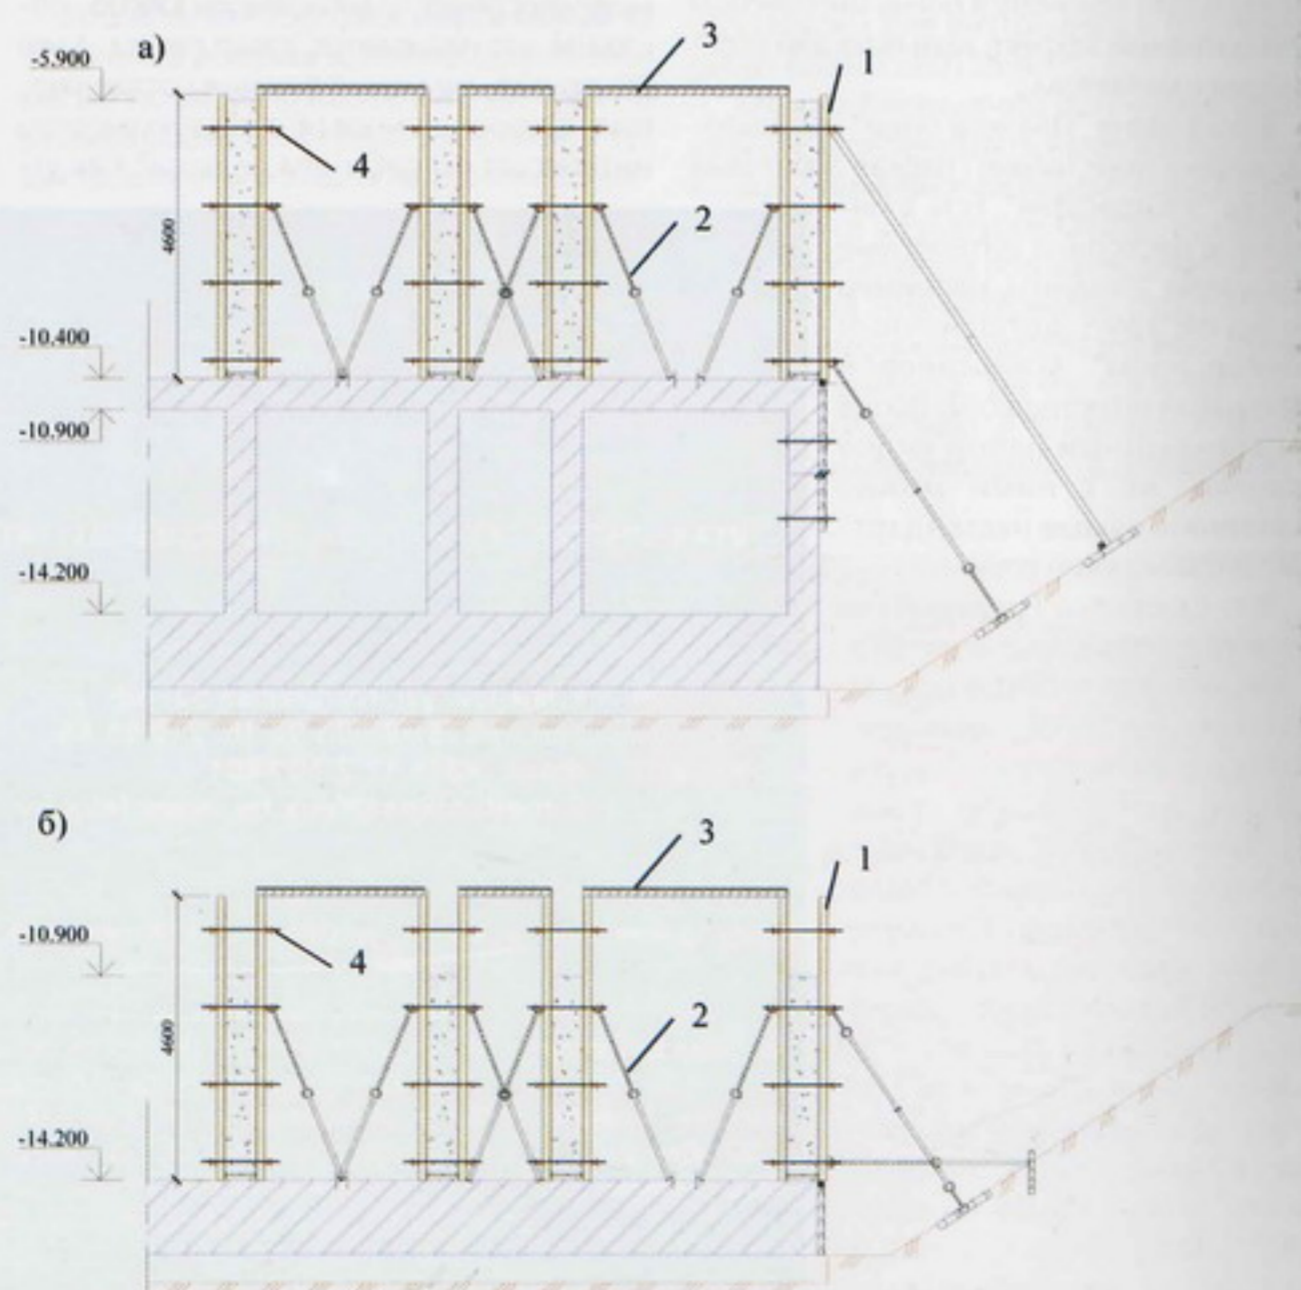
Схема опалубки монолитных стен подвала: а — возведение 1-го яруса; б — возведение 2-го яруса. 1 — щитовая опалубка; 2 — подкос из телескопических стоек; 3 — рабочий настил; 4 — винтовые тяжи
